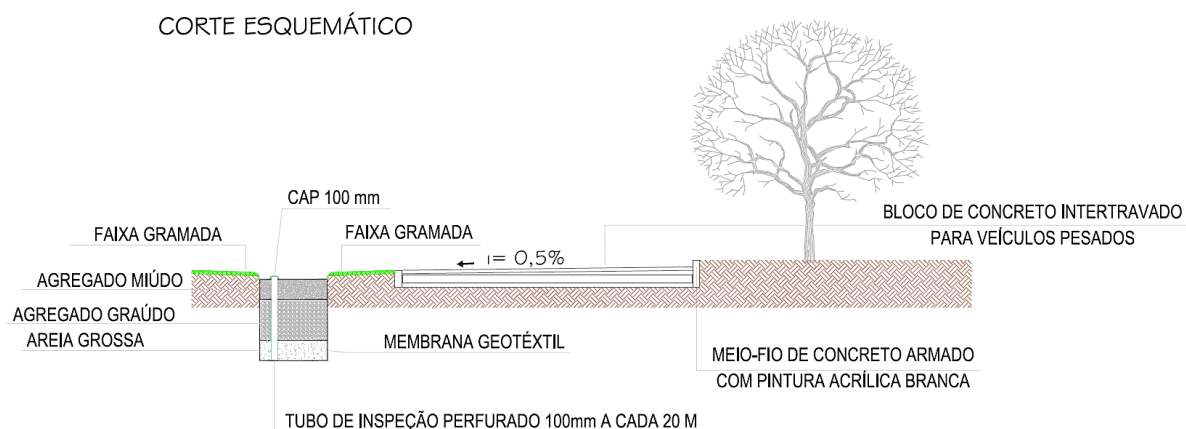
Corte transversal esquemático da trincheira de infiltração.
